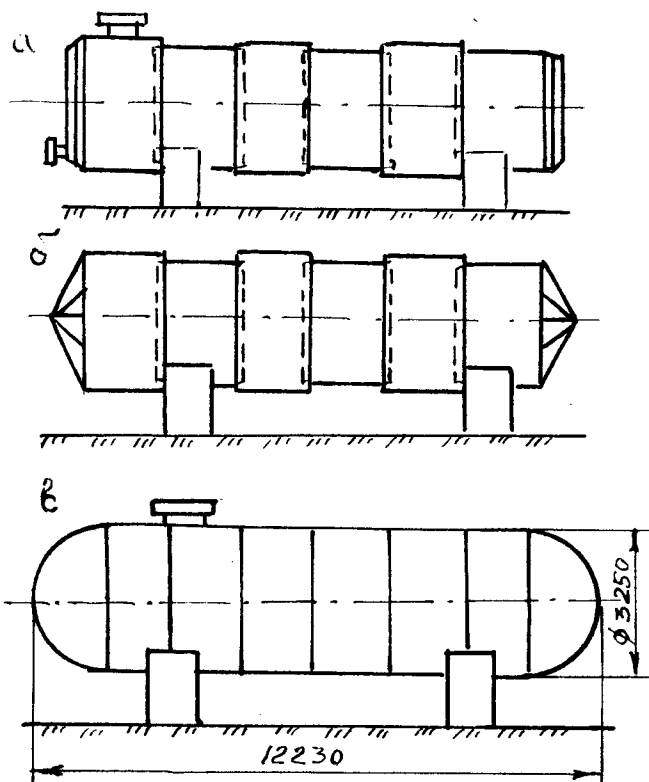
Схеми конструкцій горизонтальних резервуарів:
